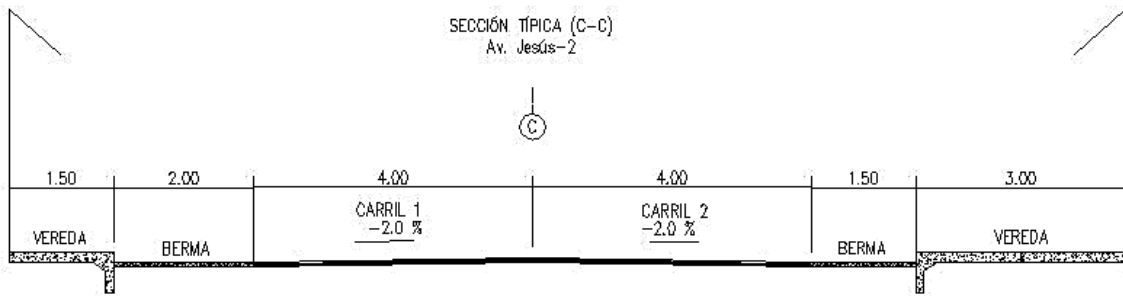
Sección Transversal de la Av. Jesús Corte C-C
